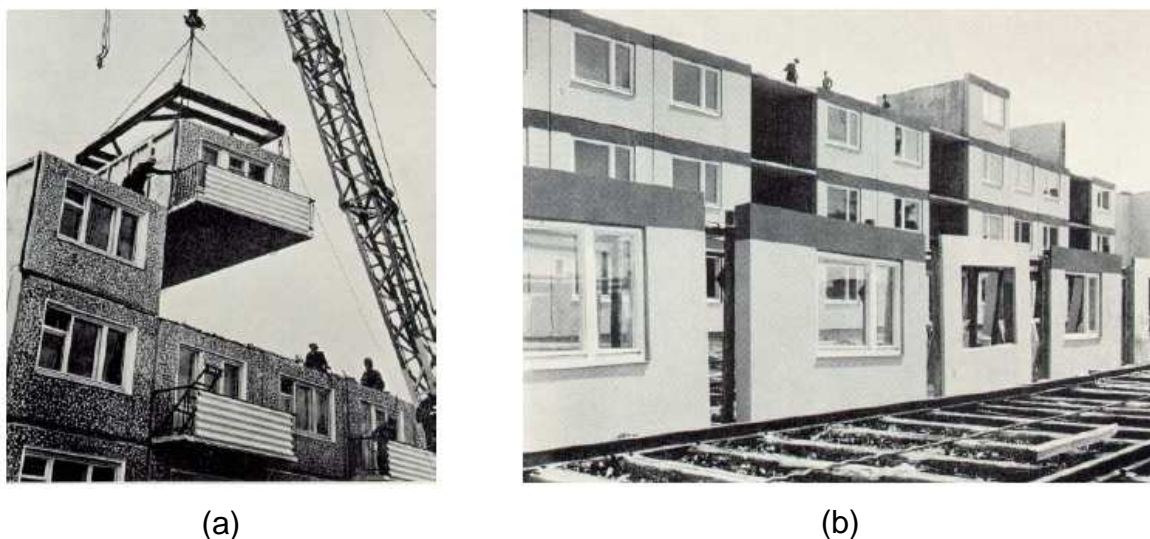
Construções com pré-fabricados em concreto leve: Rússia – 1967 (a) e Áustria – 1968 (b) (ROSSIGNOLO, 2003).
